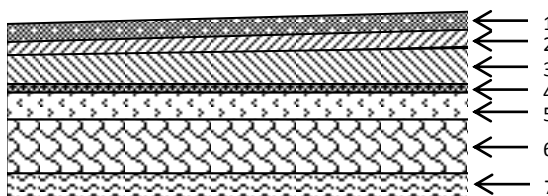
Coupe transversale du plancher terrasse inaccessible.
